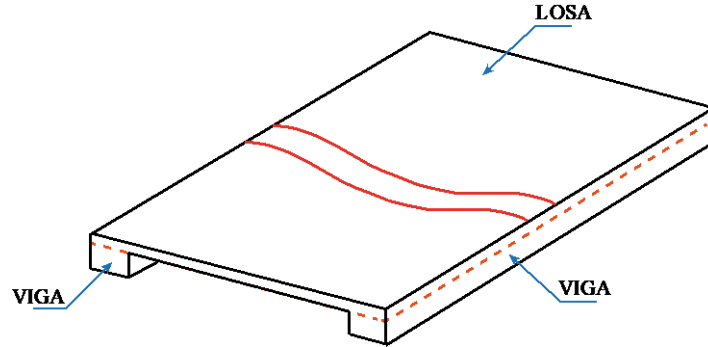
Esquema de losa en una dirección sobre bordes viga.
